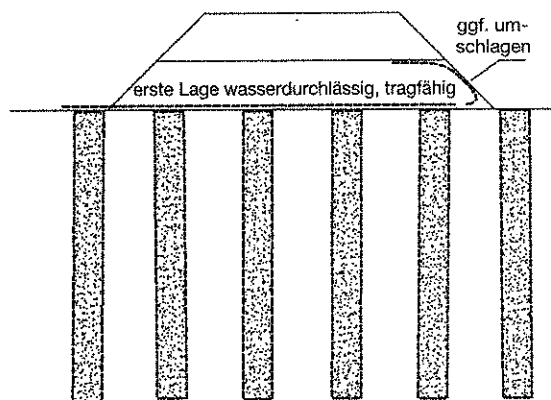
Damm über geotextil-/geogitterummantelten Sand-, Kies- oder Schotterssäulen (Durchmesser ca. ≥ 60 cm) mit Bewehrung im Dammauflager
